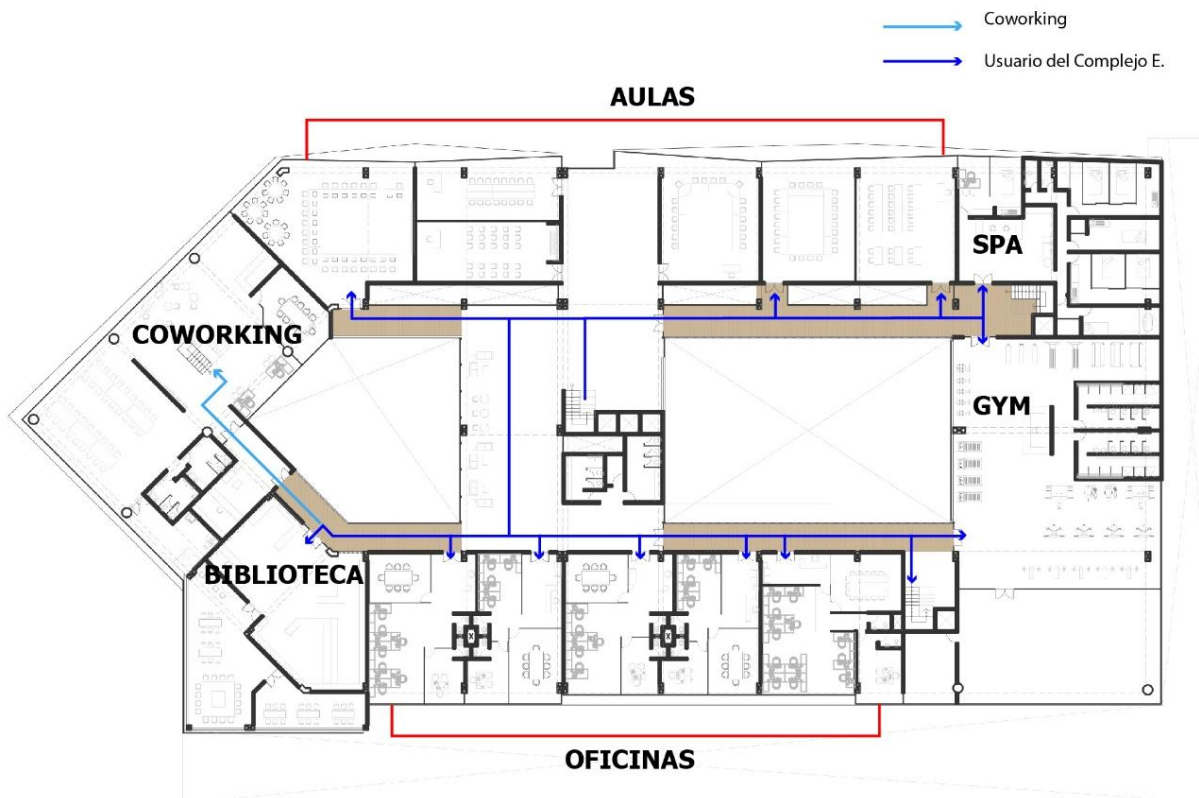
Elaboración Propia. Flujos y distribución de Segunda Planta.
